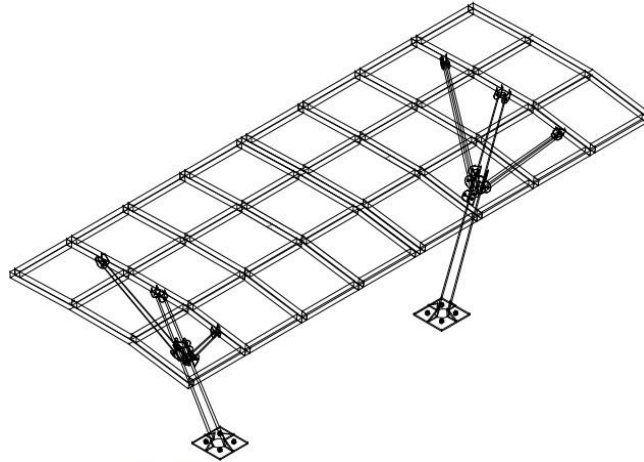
Vista en planta de 2 paneles solares juntos. | Fuente: Autores
